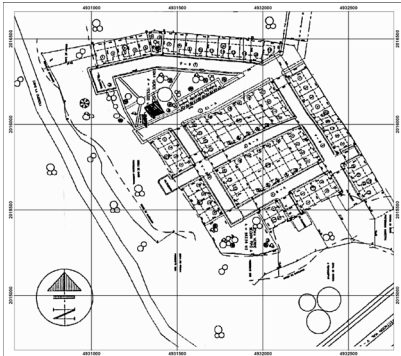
Planimetría de proyecto urbanístico (Década de 1970). Fuente: Archivo municipal
